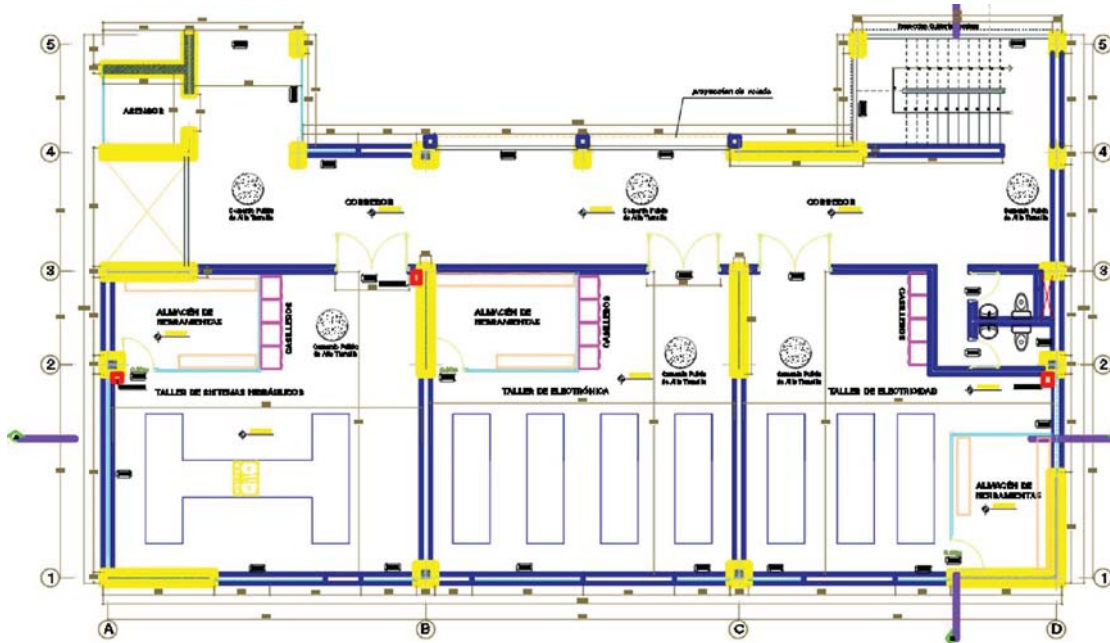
PLANTA DE DISTRIBUCION 2DO NIVEL
